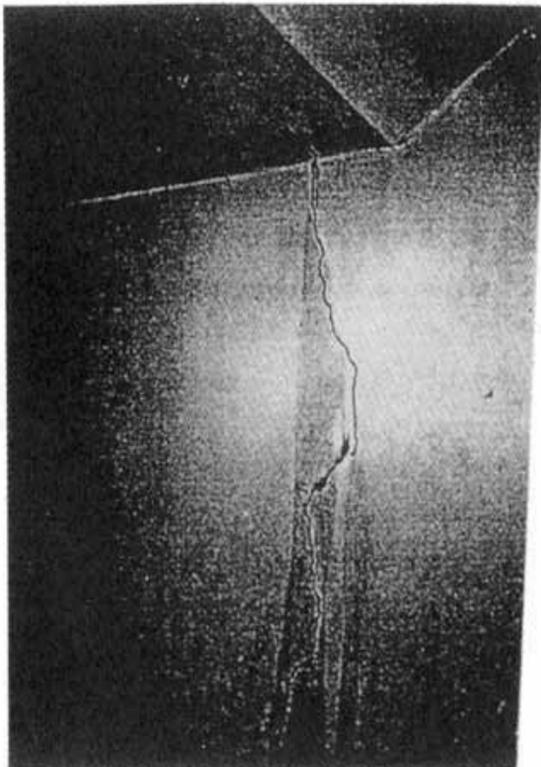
三宮第2駐車場・壁のひび割れ(被害タイプC)
